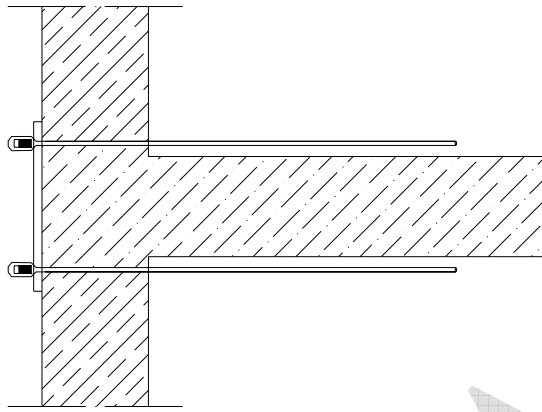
Vista in pianta di catena binata aderente al muro trasversale a livello del solaio
